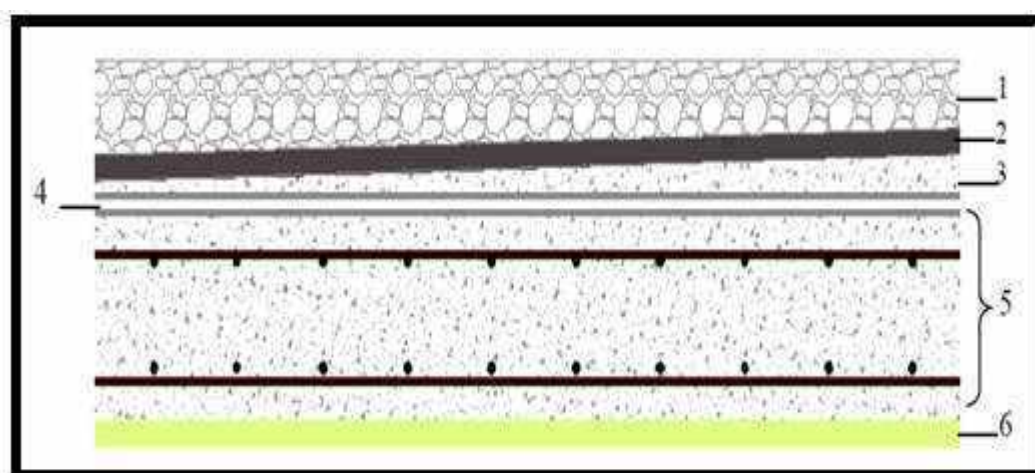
Composants d'un plancher terrasse en dalle pleine.
